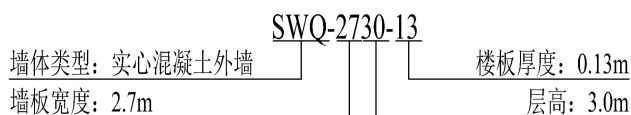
无洞口实心混凝土外墙编号规则示意图
